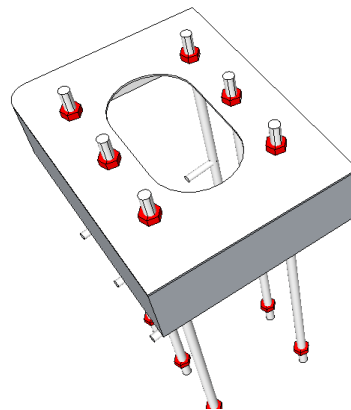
inserimento delle aste di ancoraggio nel telaio superiore (vista dall'alto)
